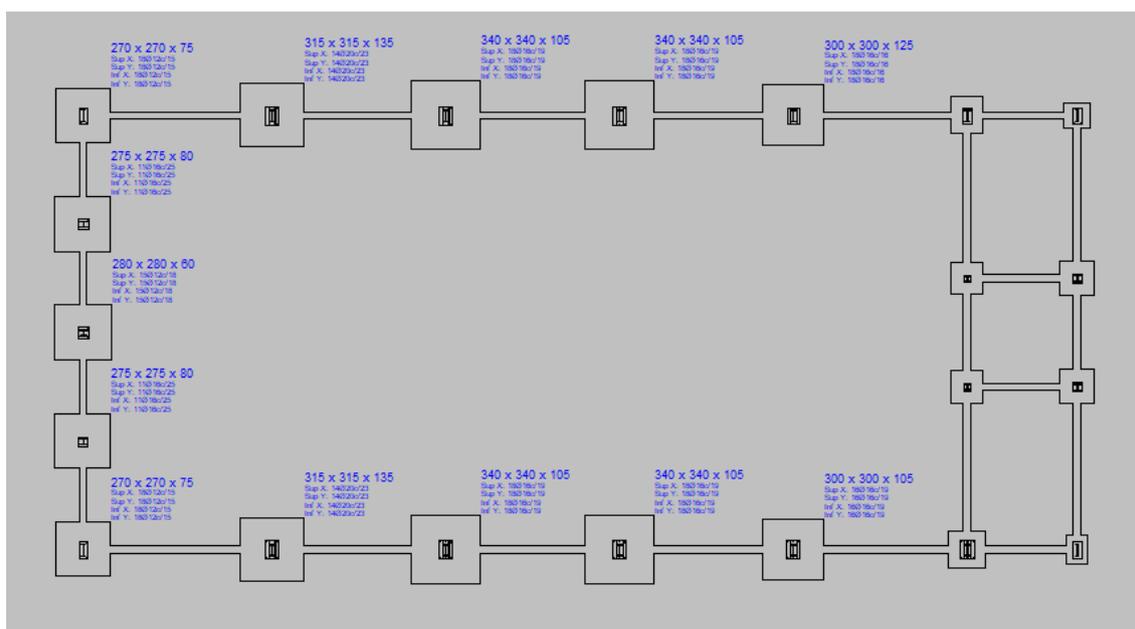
Primera cimentación. Fuente: CYPE 2017
